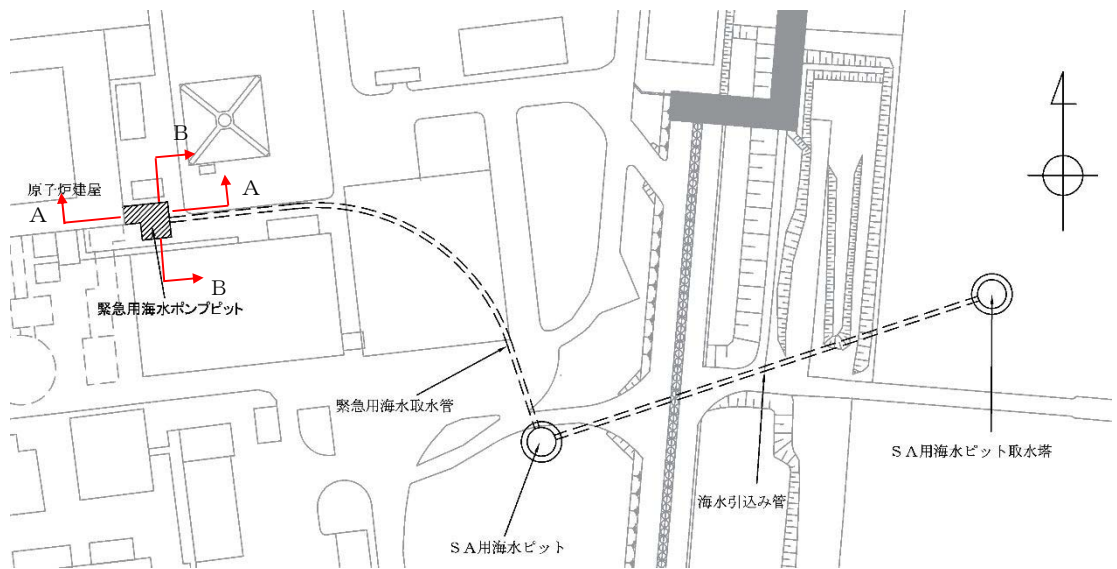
(2) 緊急用海水ポンプピットの平面配置図 (拡大図)
